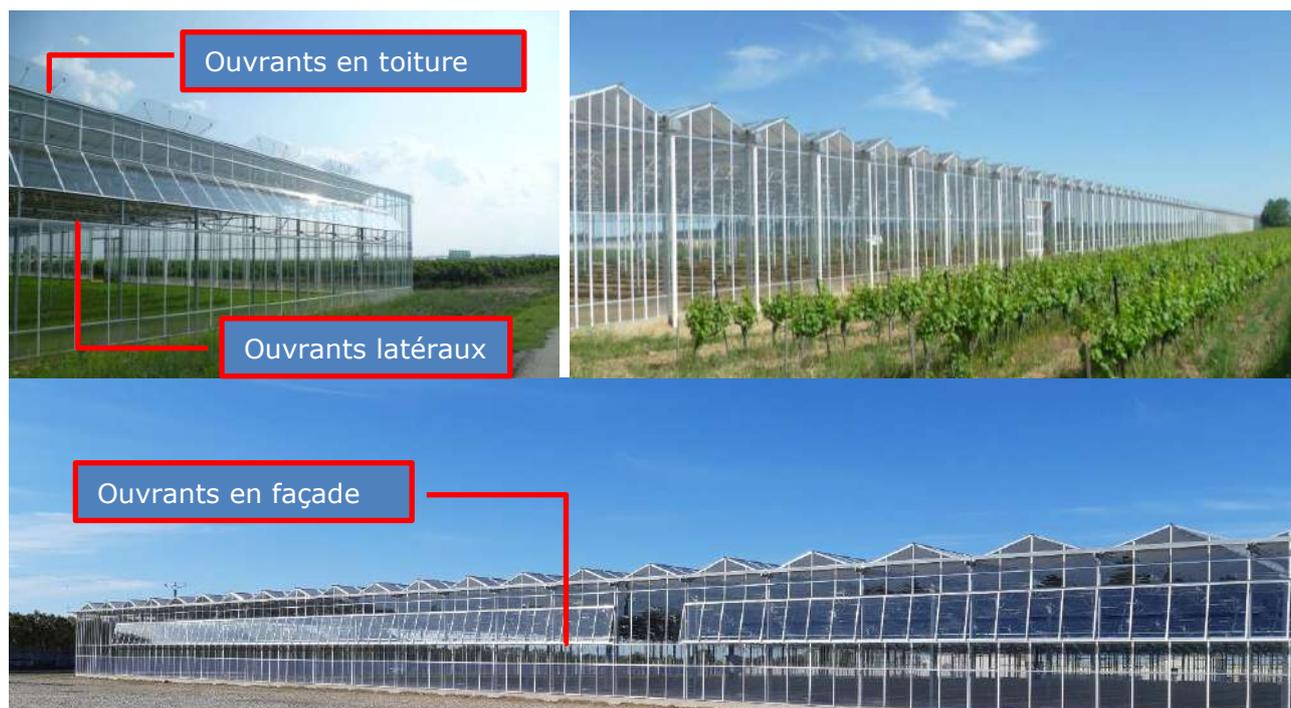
Ouvrants en façade et en toiture. Source : Reden Solar.
